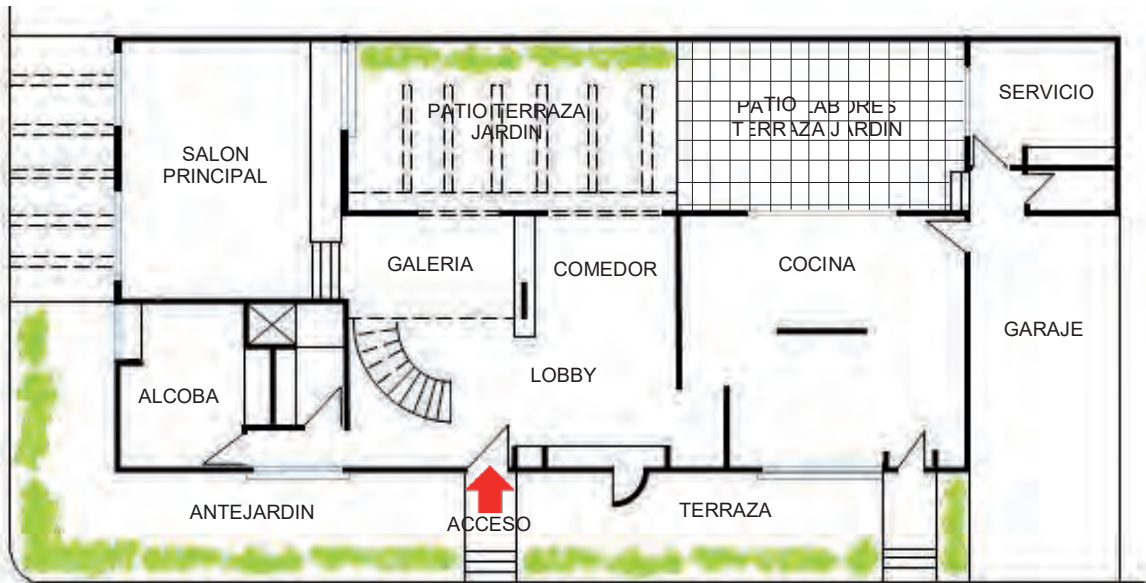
Planta arquitectónica 1er piso casa Lemaitre. Fuente: Archivo personal.
